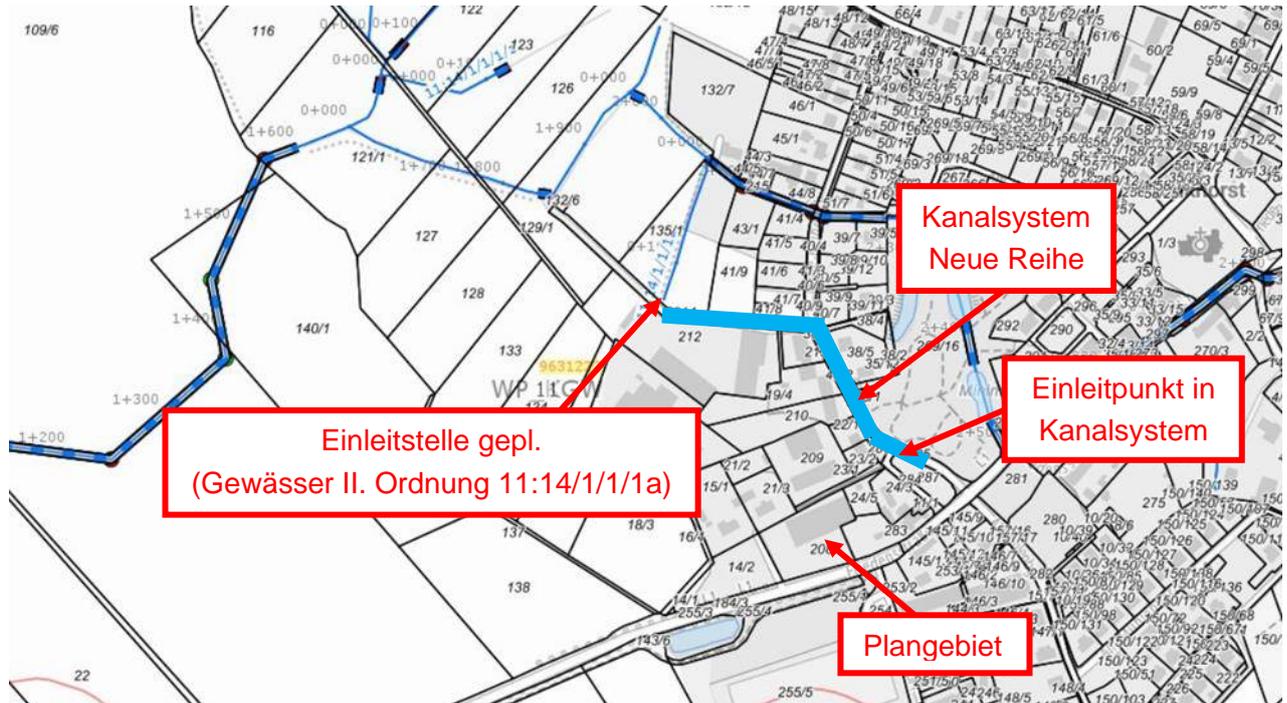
Übersichtslageplan gepl. Niederschlagsentwässerung
